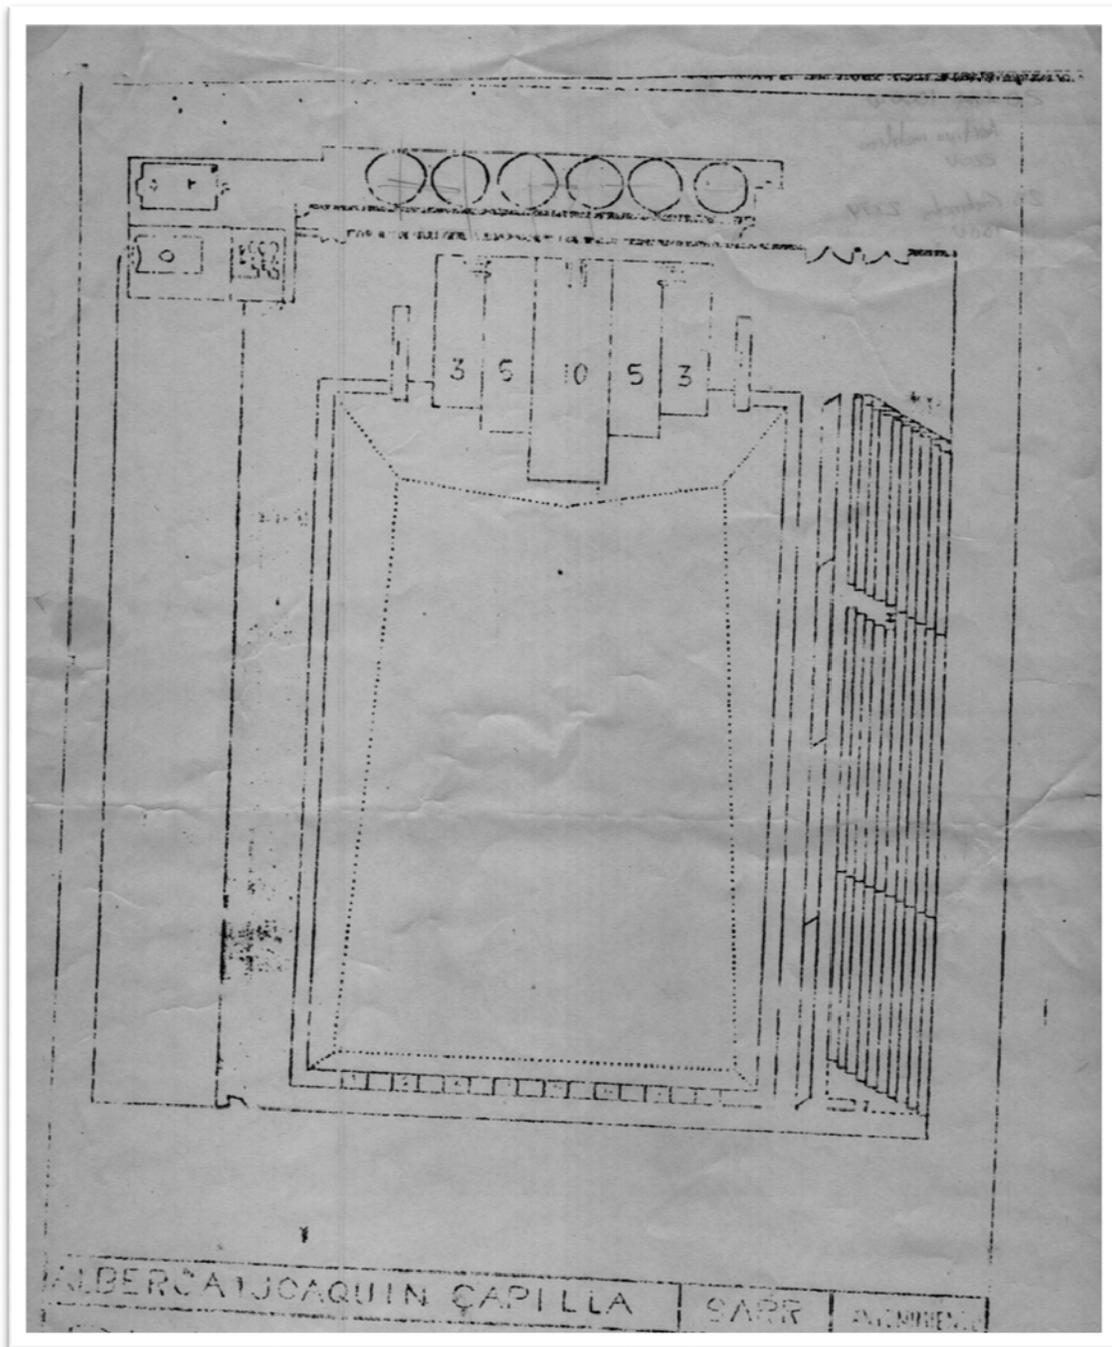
Plano de la alberca Joaquín Capilla con el que cuenta el Plan Sexenal.
